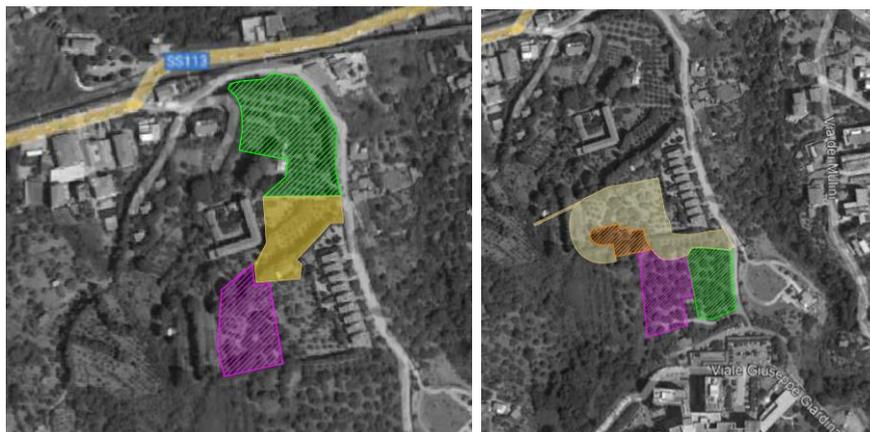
cantierizzazione approvata (a sx) nuova cantierizzazione (dx)
